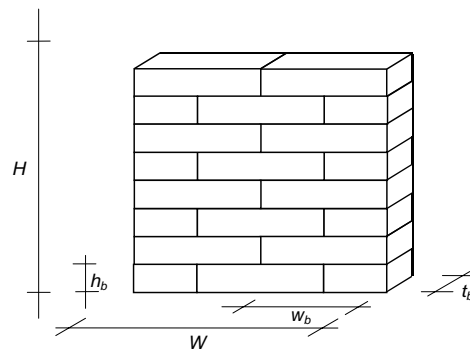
Dimensiones de los muretes de compresión simple y excéntrica
